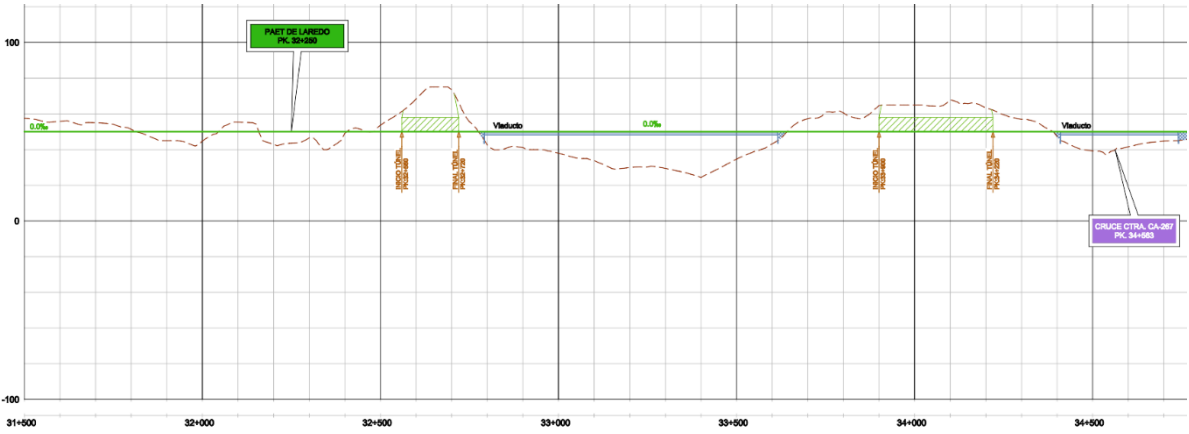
Perfil longitudinal Alternativa C1 rasante baja. PAET Voto
